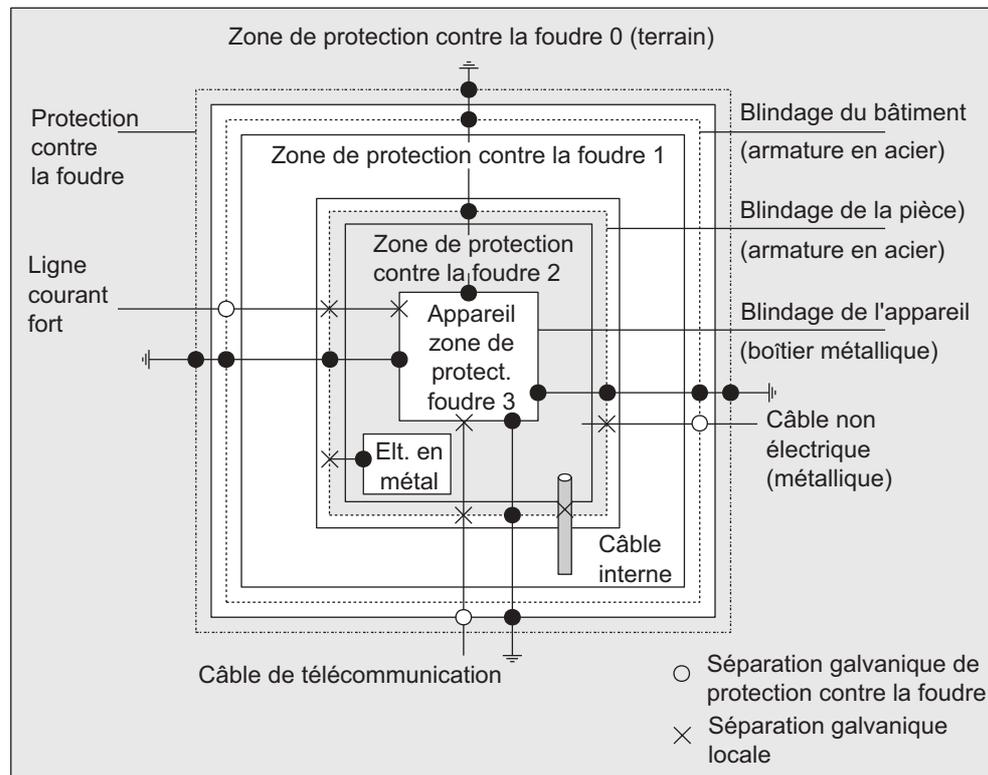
Zones de protection contre la foudre d'un bâtiment
